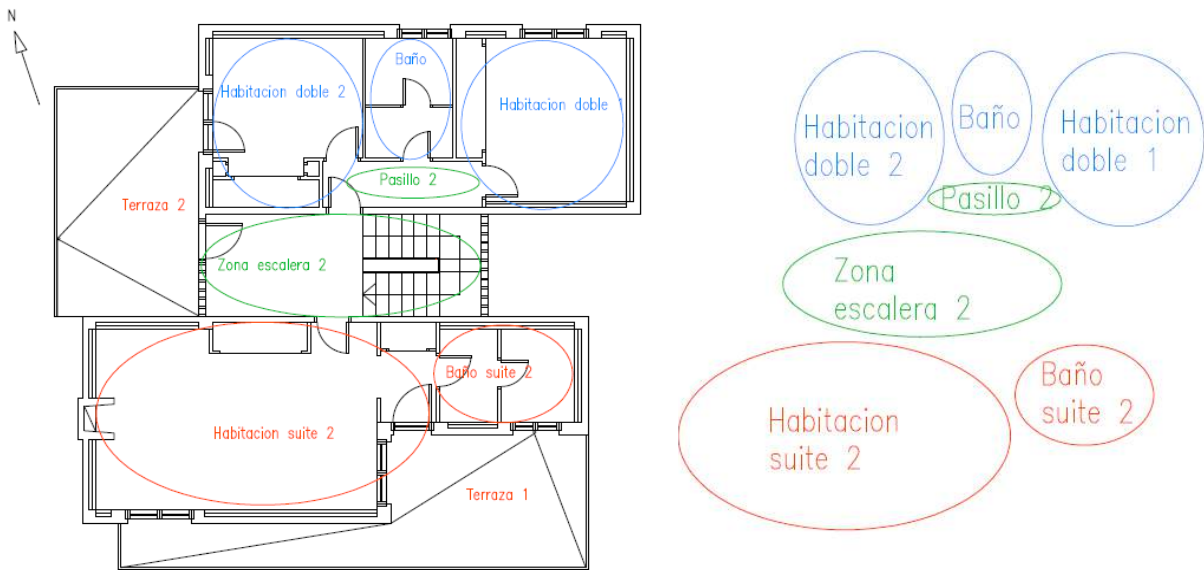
Distribución de zonas frías / calientes en planta piso, proyecto original.
